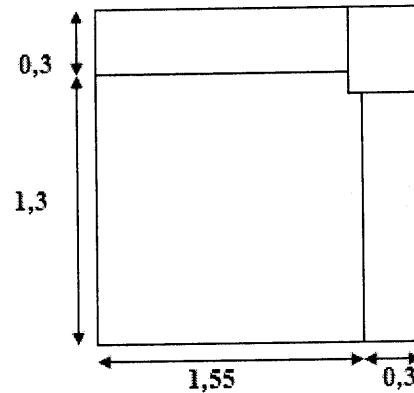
dimensions de la section revenant au poteau d'angle.
